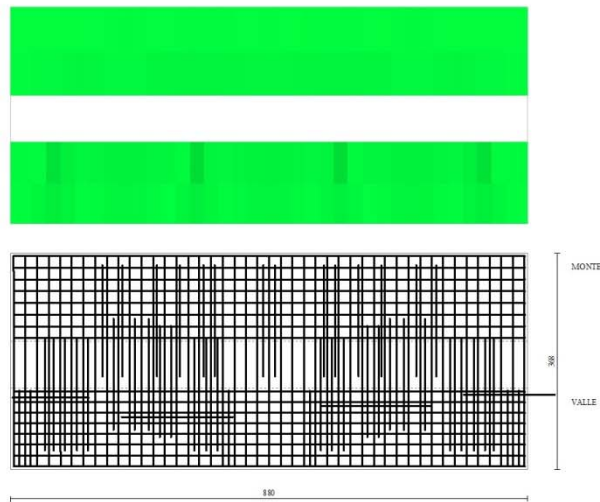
Piastra fondazione dir. X (Inviluppo)
